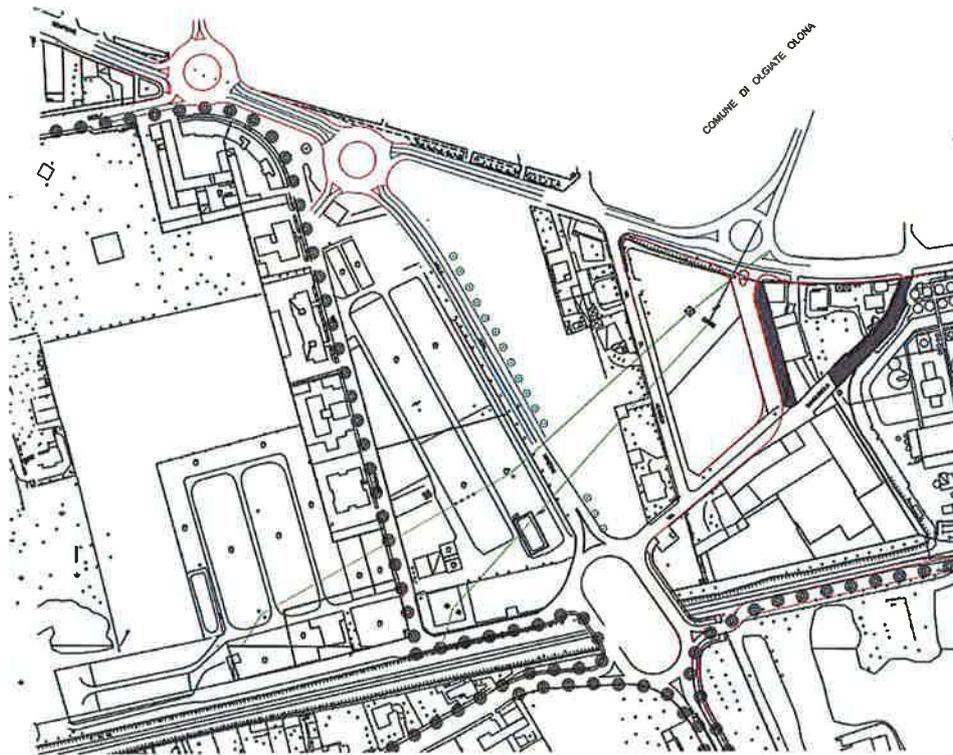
Planimetria schematica dell'intervento – scenario di riferimento.
